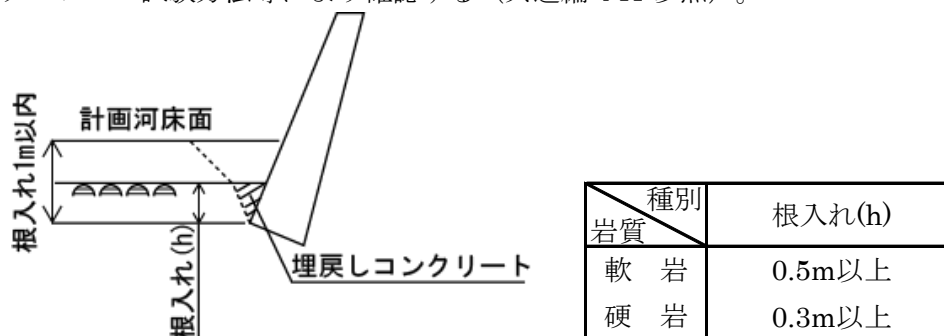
護岸工の根入れ例（岩盤基礎）
